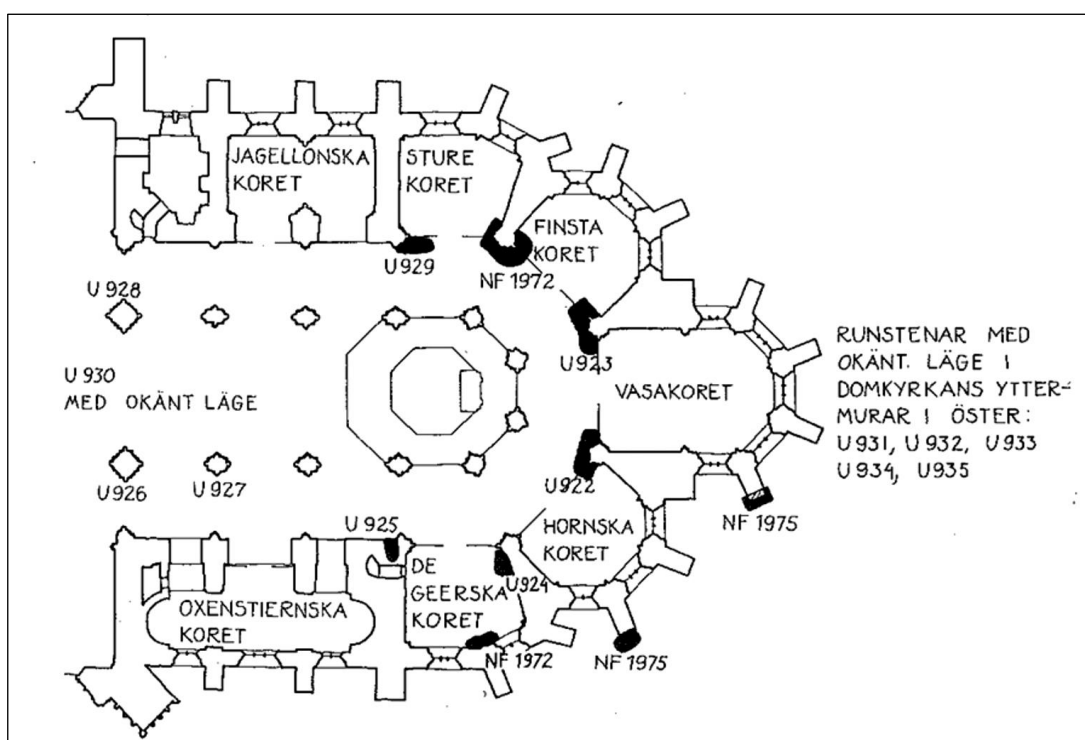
Planta de pedras rúnicas colocadas como fundamentos para os pilares do presbitério da catedral gótica em Uppsala.
